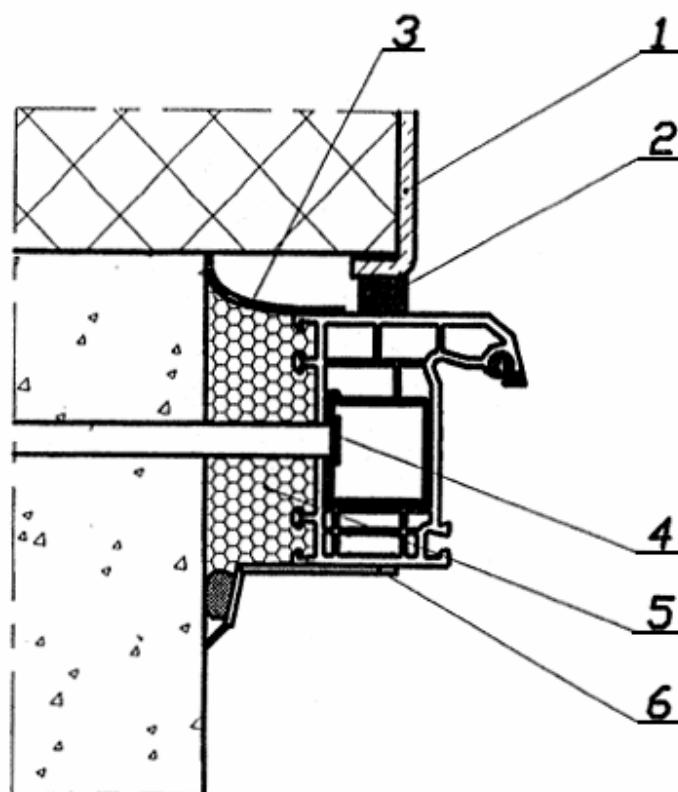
Узел бокового примыкания оконного блока к проему стены из бетона с наружным утеплением фасада и установкой внутреннего декоративного нащельника с пароизоляционной системой:
